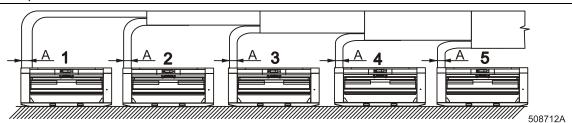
C Entlüftungsleitung für eine Bügelmaschinengruppe
